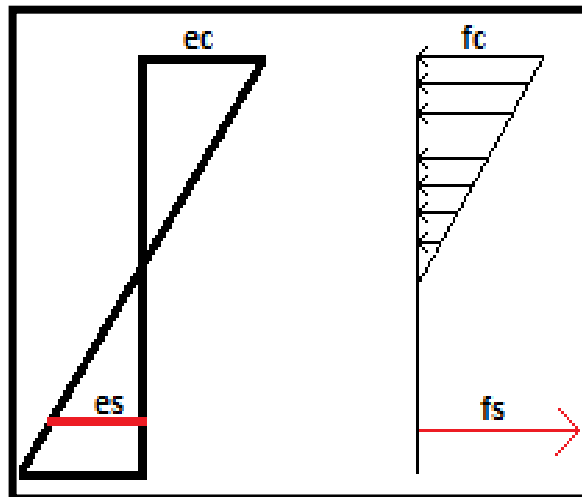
Agrietamiento del concreto por tensión en las fibras inferiores
